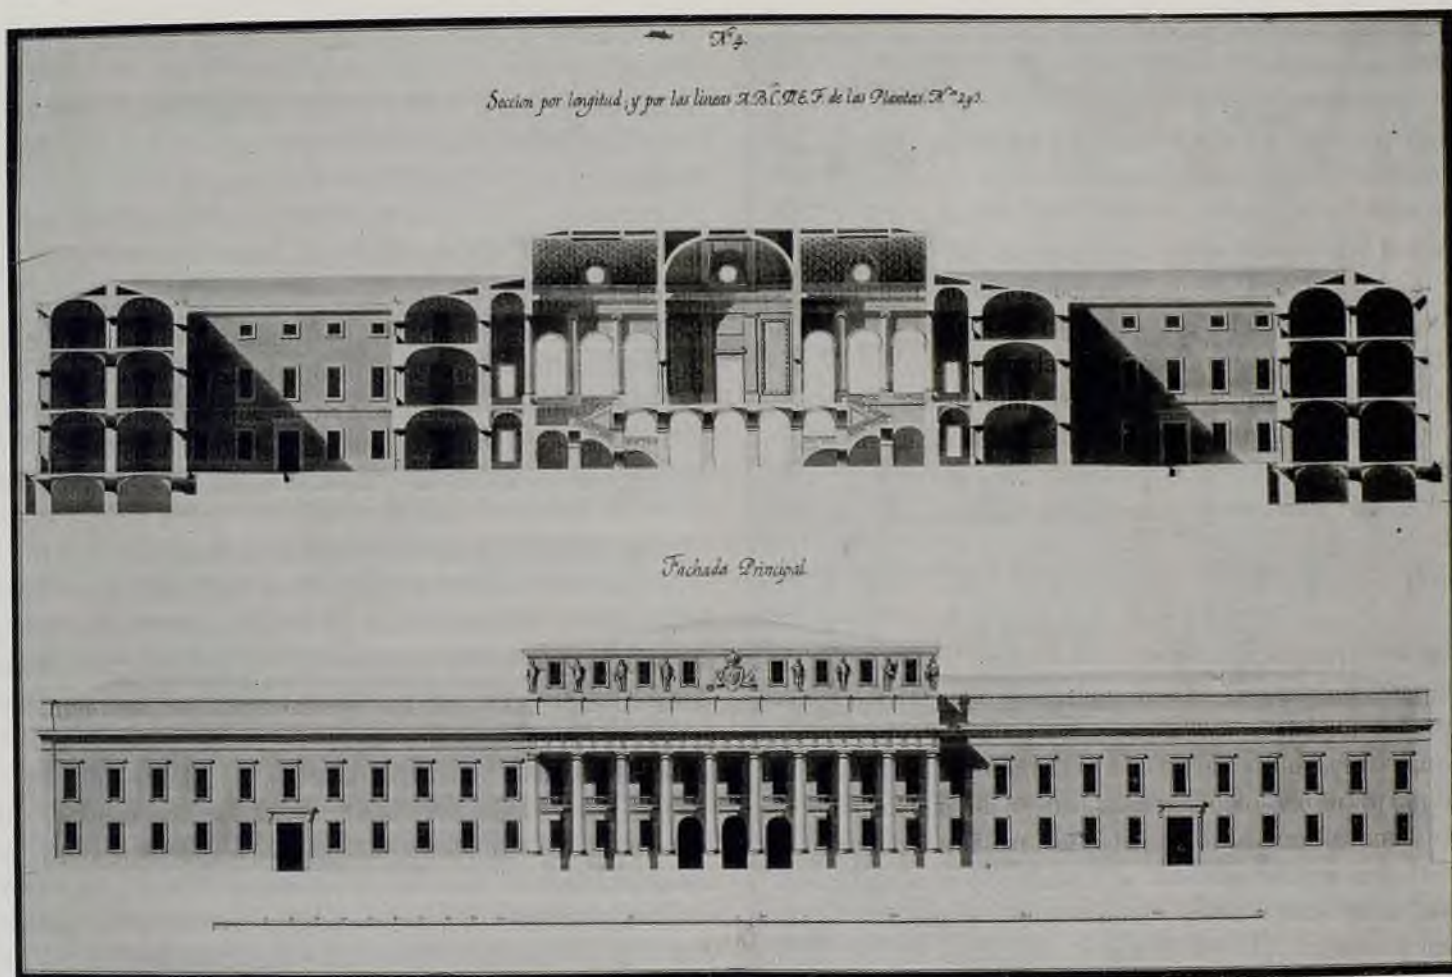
Juan Gómez, Alzado y sección del proyecto para una Casa de Contratación en Madrid, 1796.
